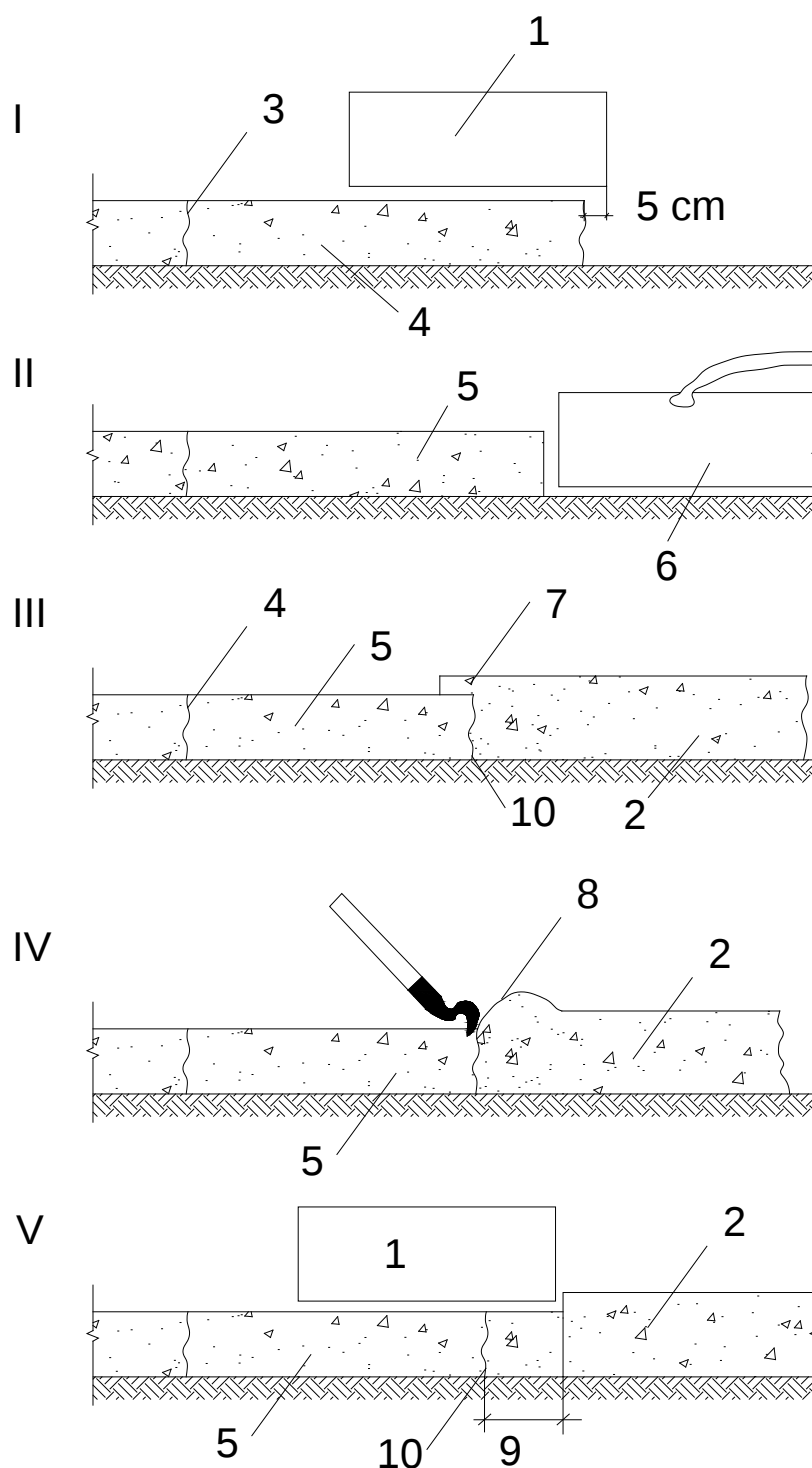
Схема уплотнения примыкающей к затвердевшему бетону продольной полосы основания с устройством холодного продольного шва
